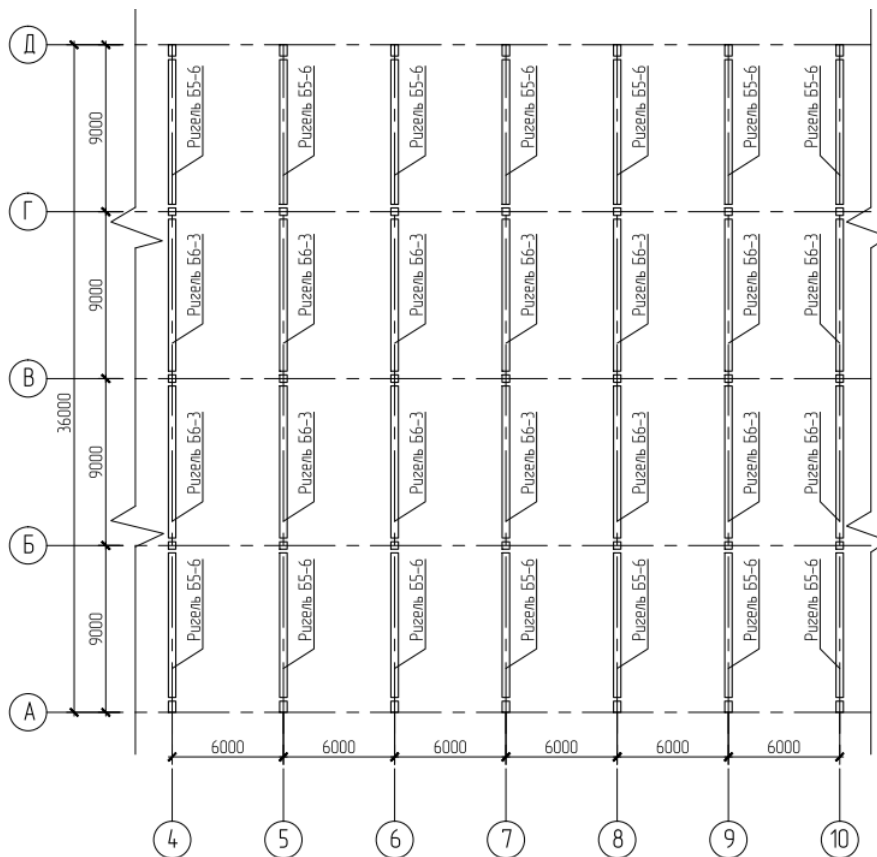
План расположения ригелей перекрытия первого этажа в осях А-Д/4-10
